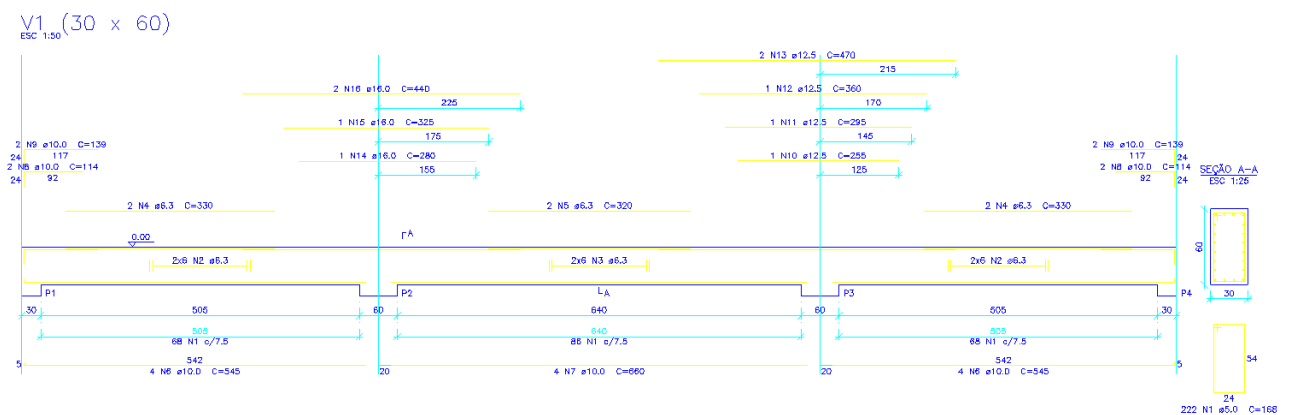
Detalhamento das armaduras da viga V1 via Eberick
